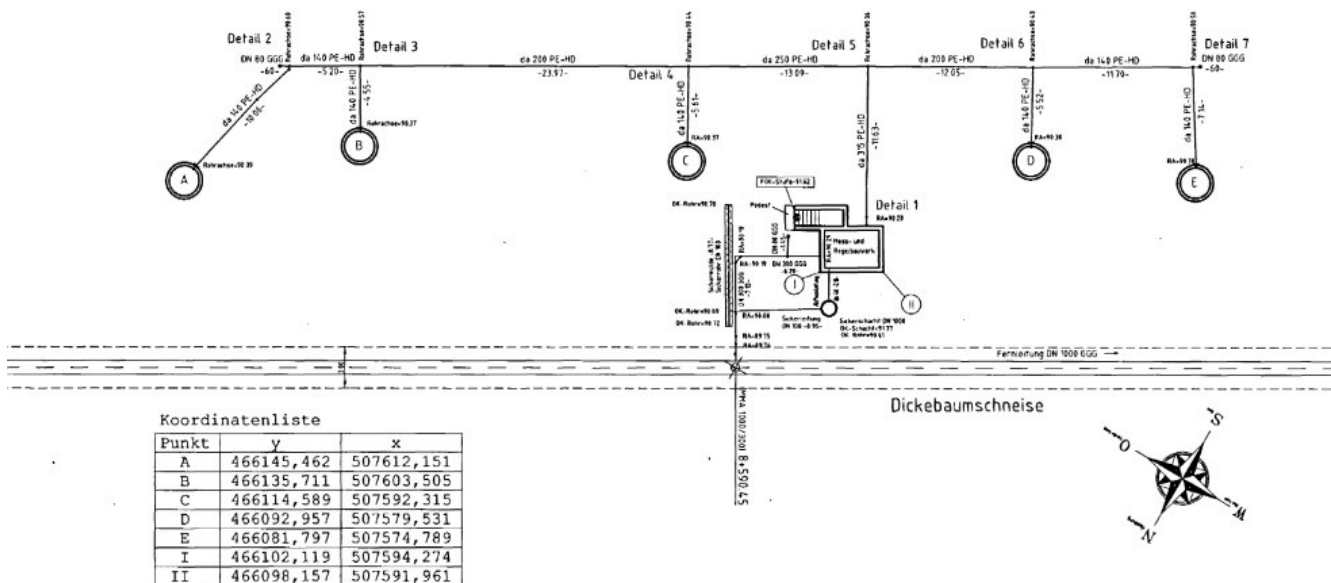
Lageplan des Infiltrationsorgans 7 im Jägersburger Wald
